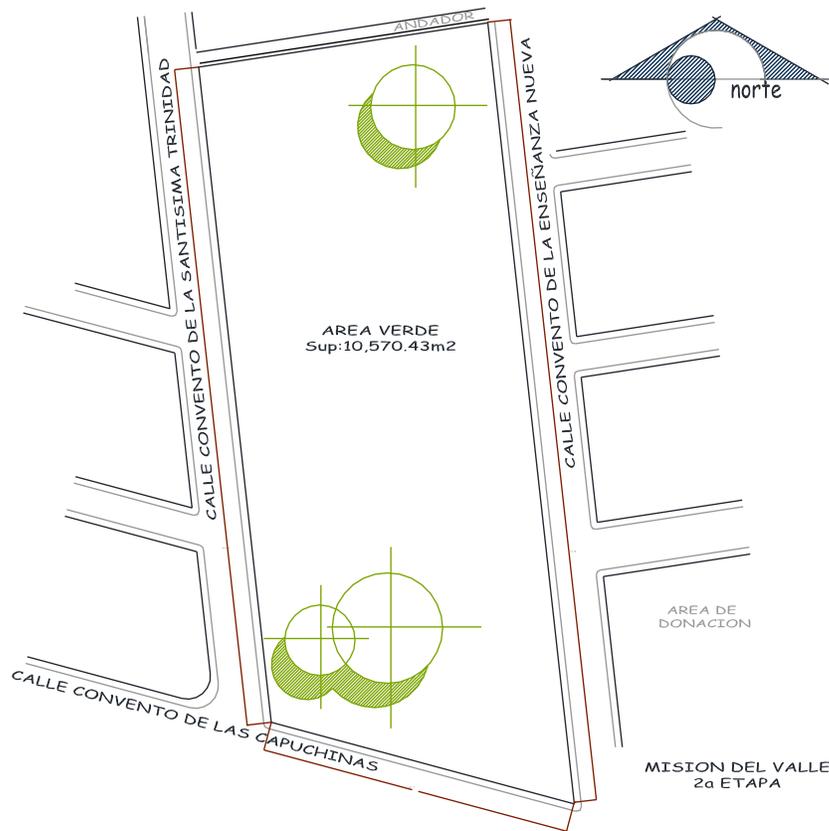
Plano del terreno realizado por M.G.C (realizado el 05/09/2016)
